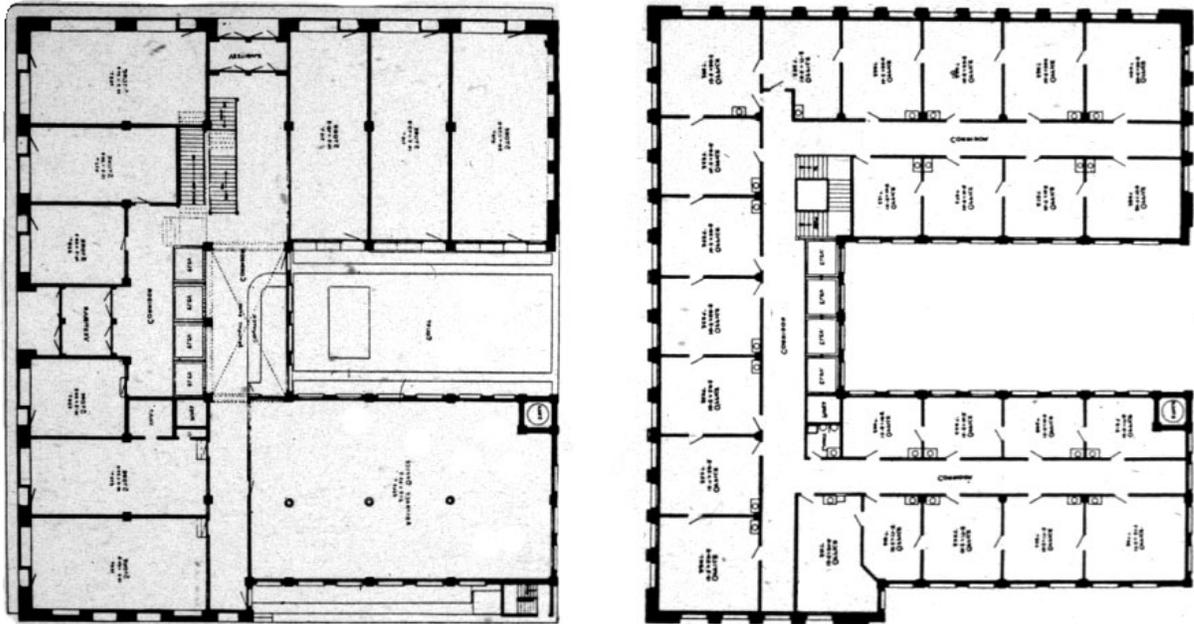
Plano para edificio de oficinas de Louise Sullivan.
